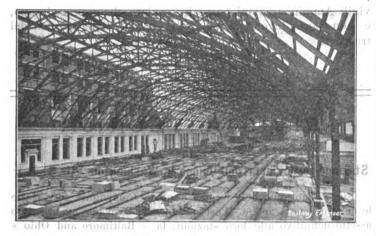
Stazione ferroviaria di Washington. - Vista della tettoia.
